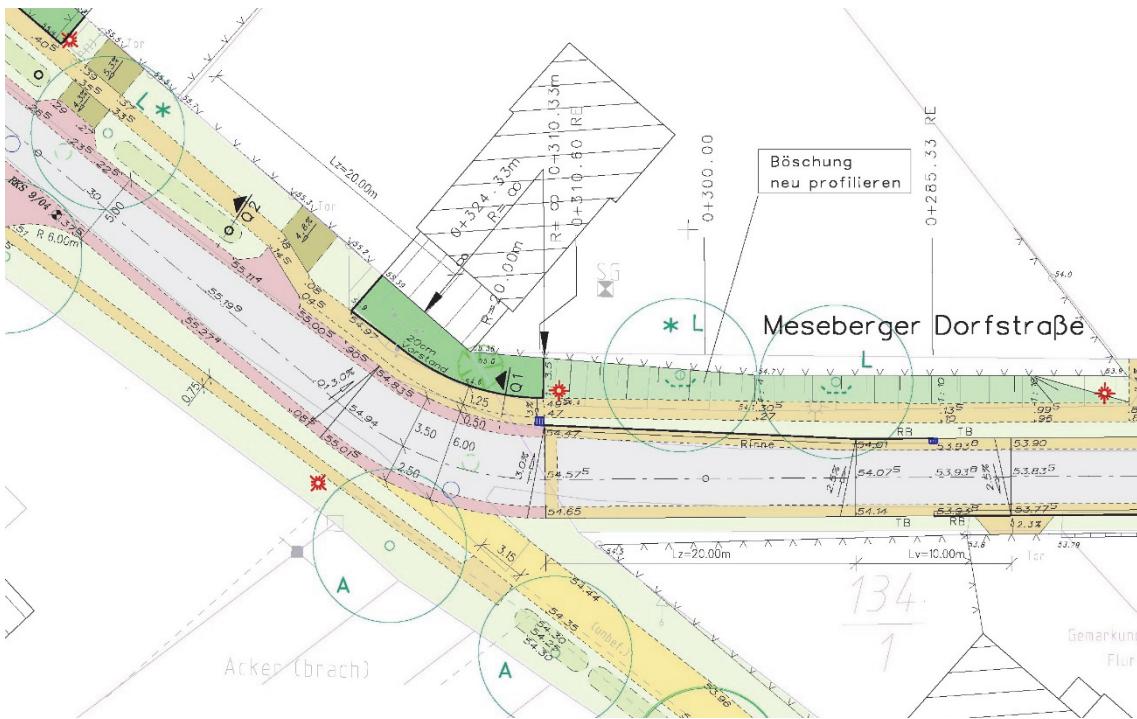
| Übergangsbereich im Lageplan: Belagswechsel im Zuge der fahrbahnbegleitenden Seitenstreifen von mehrzeiligem Betonsteinpflaster in der Zufahrt zum Anger (rechts im Plan) zu großformatigem Natursteinpflaster im zentralen Angerbereich (links im Plan)
